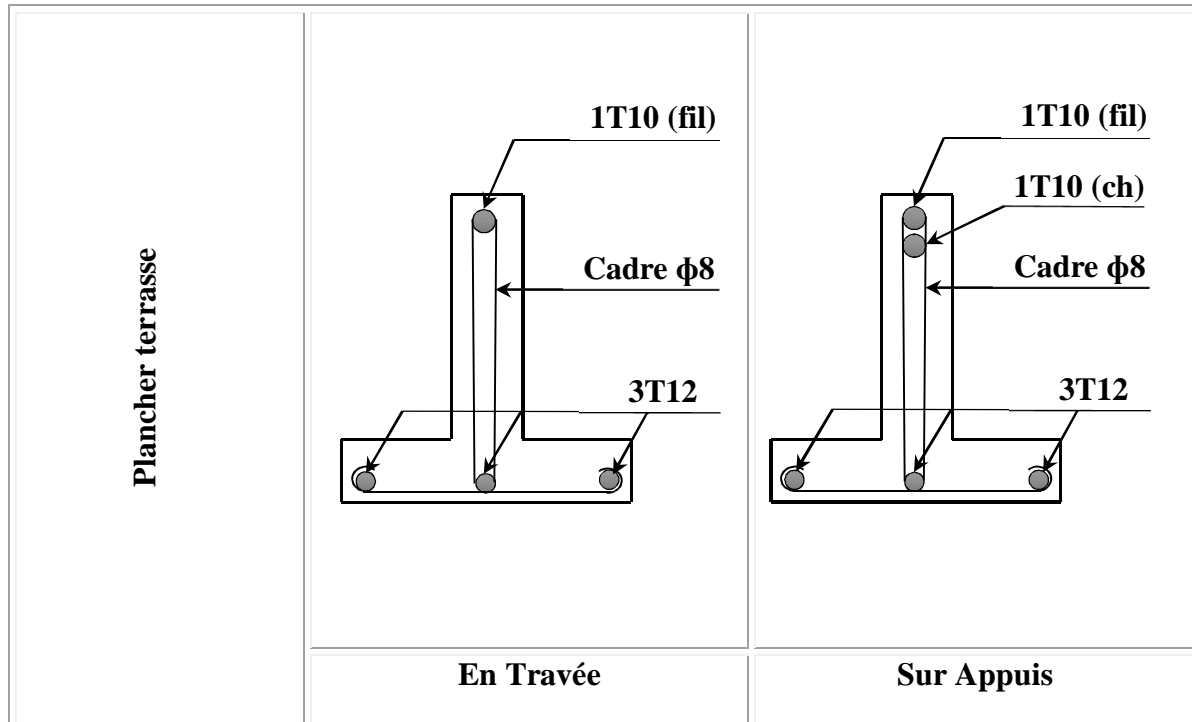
Dessin de ferrailage des poutrelles de terrasse
